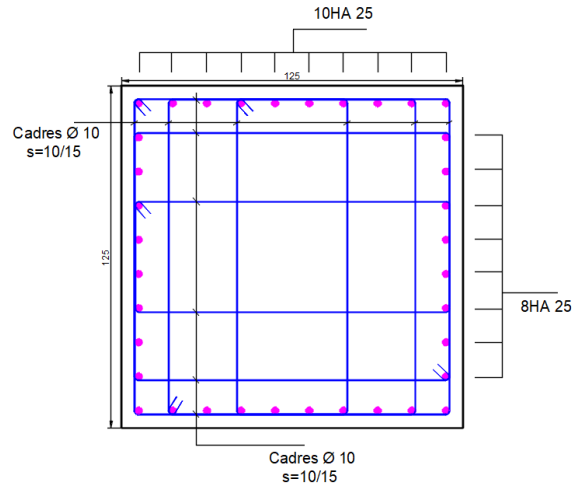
Ferrailage des poteaux 125 × 125.
